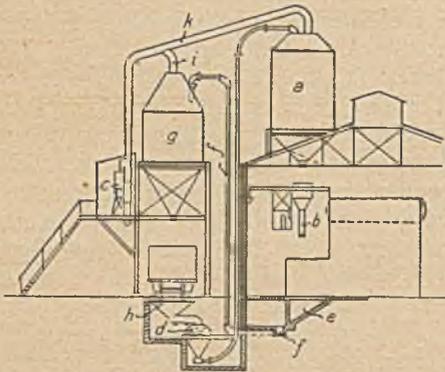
Kleinere Saugluftförderanlage für Kohle und Rückstände mit einer Pumpe.
